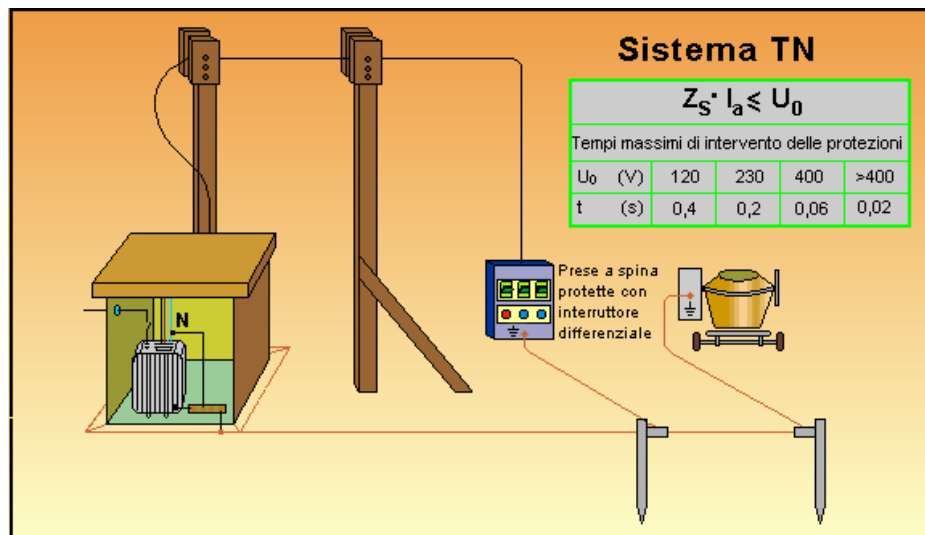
Alimentazione da propria cabina di trasformazione con sistema TN
